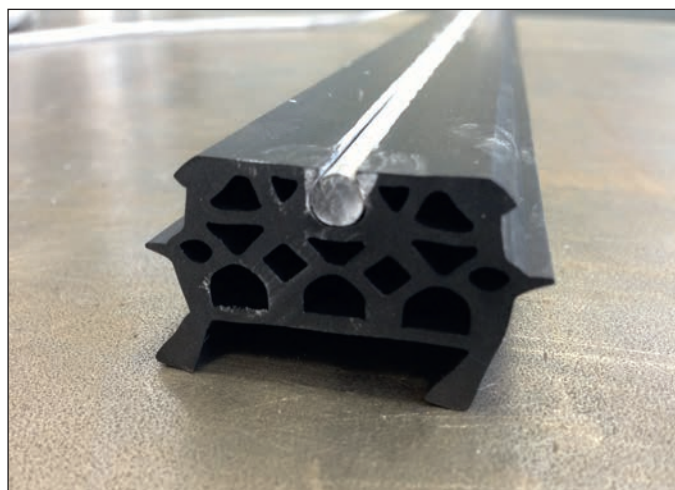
Joint mixte ancré de voussoir M 389.23 TYPE CVV
